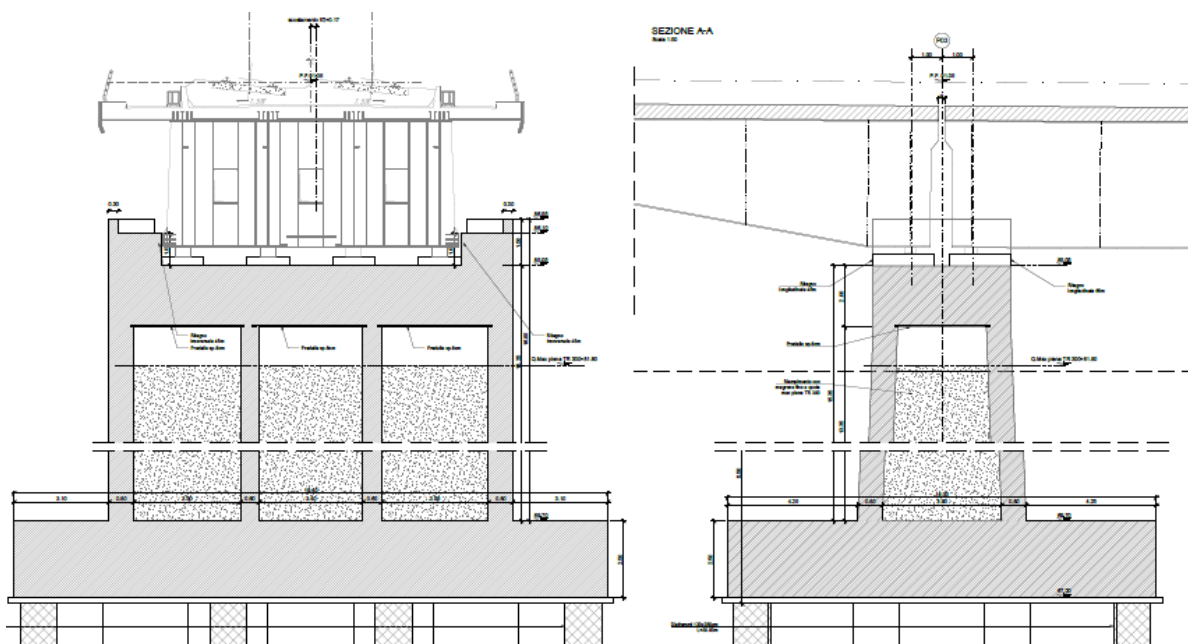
Sezione in direzione trasversale e longitudinale rispetto all'asse del viadotto pila P3
